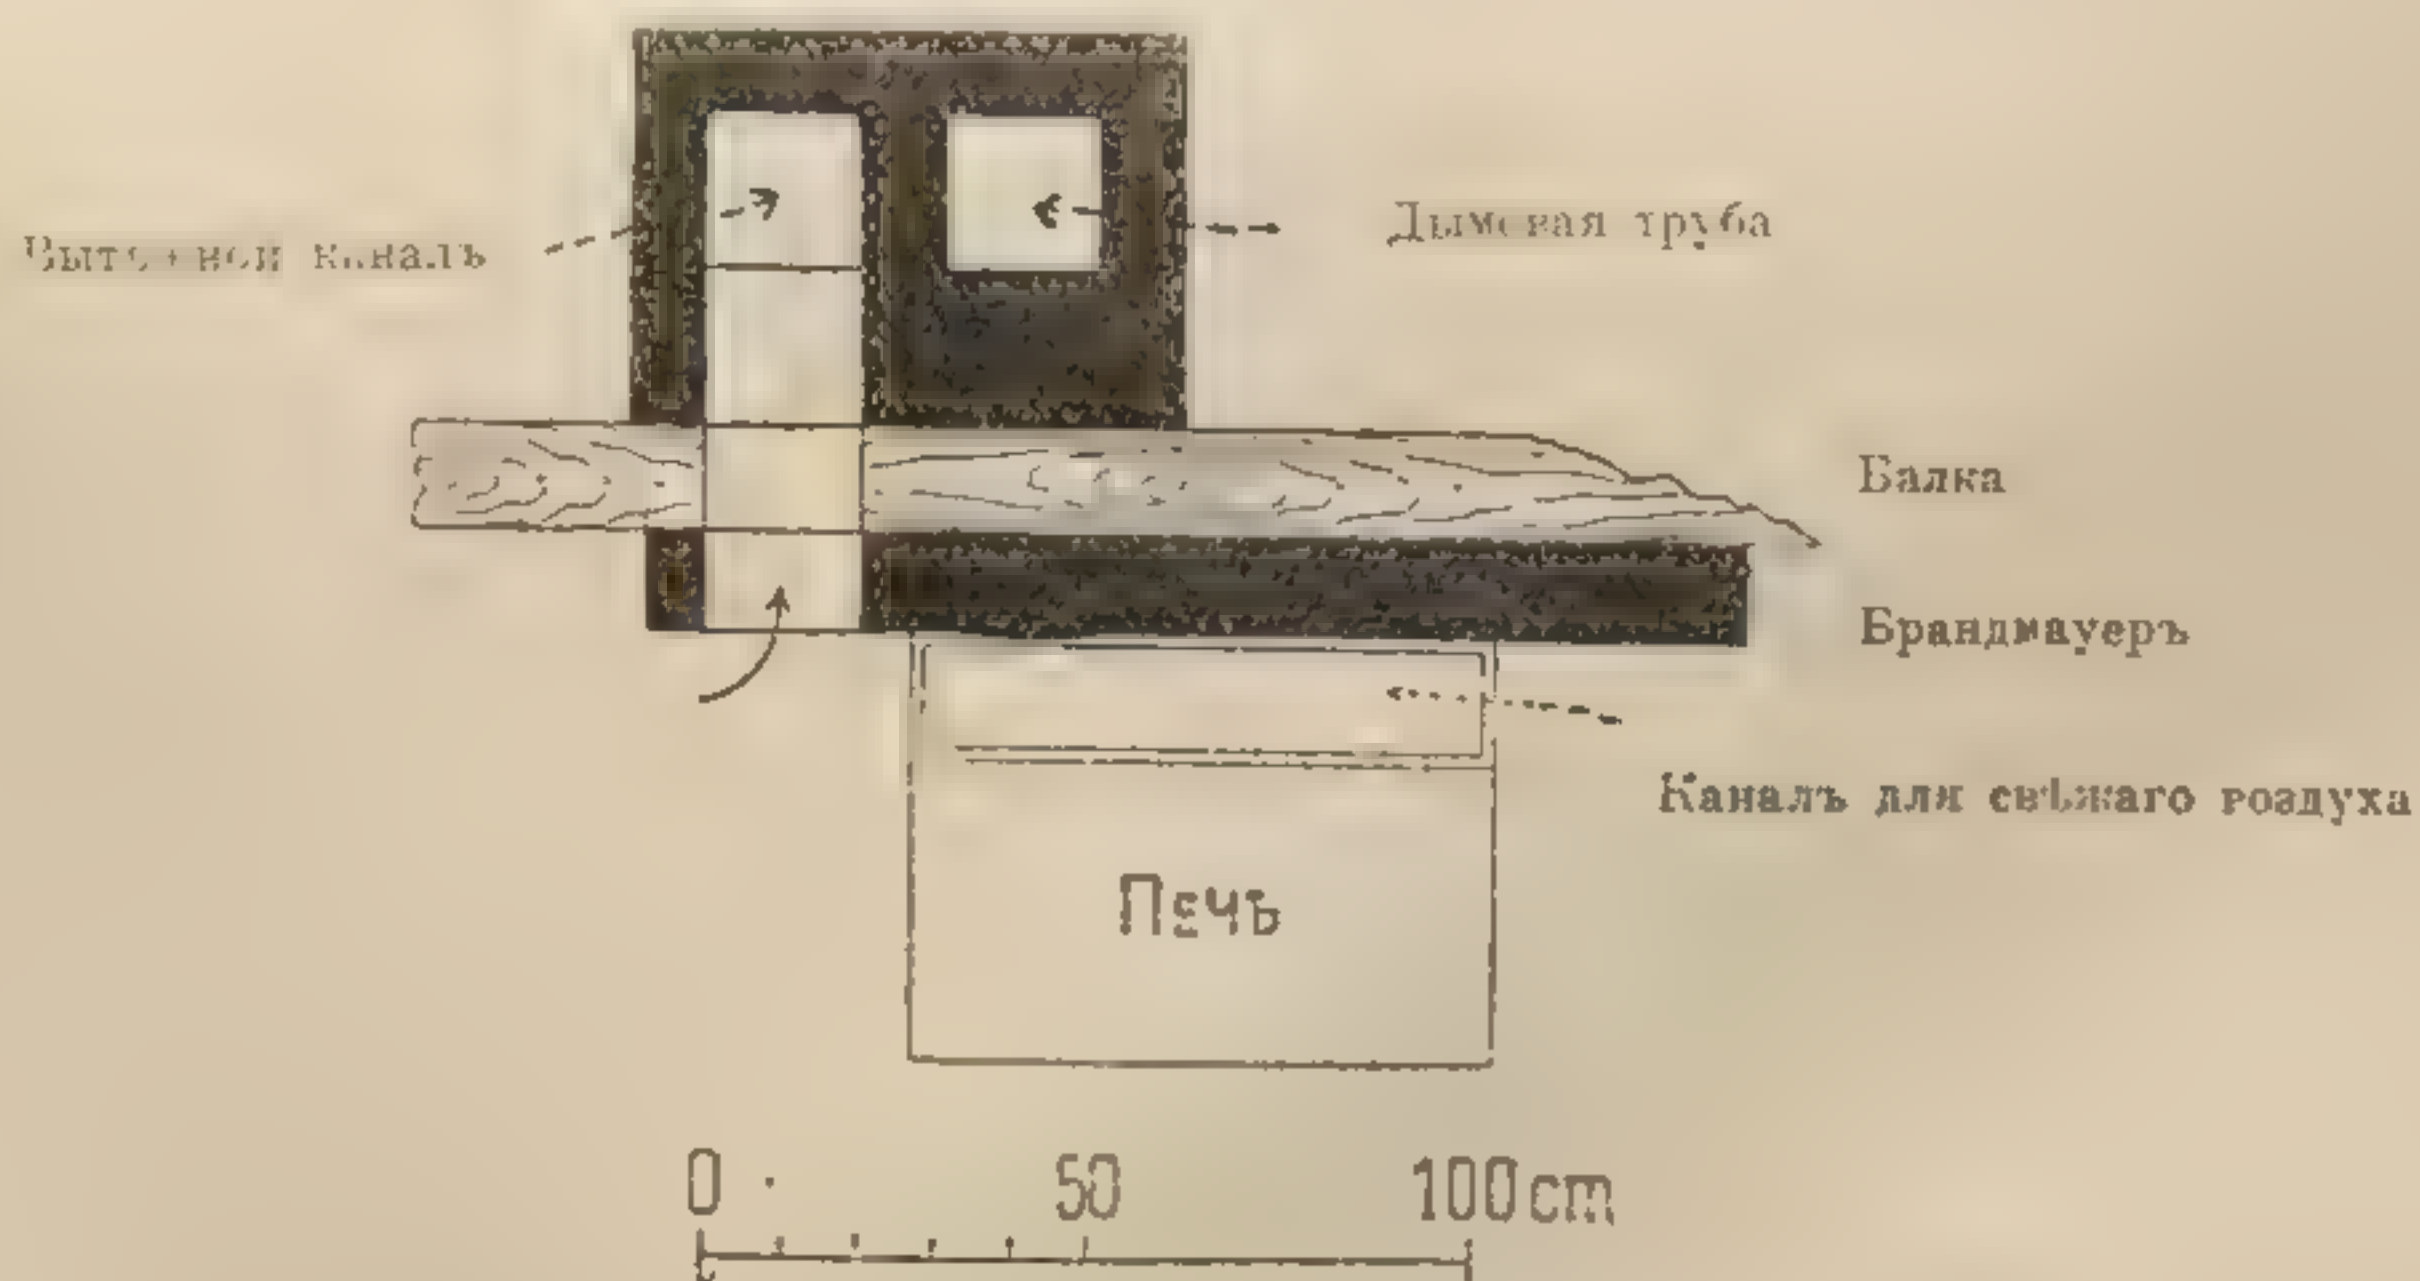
Отопленіе печами и вентиляціонныя приспособленія при нихъ для деревянныхъ зданій сельскихъ школъ по норвежскимъ образцовымъ чертежамъ.
